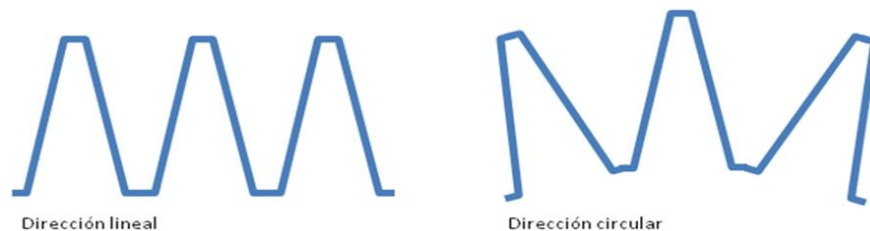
Vista en planta de dos direcciones de un aliviadero de laberinto Trapezoidal.
